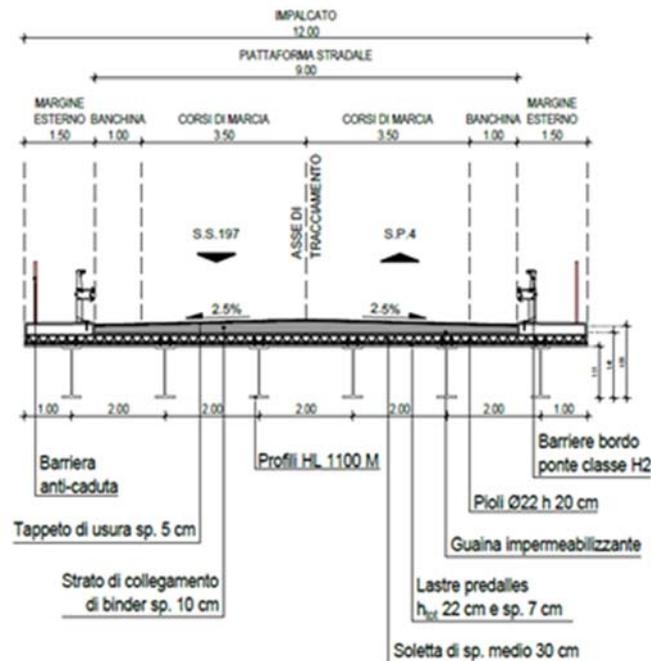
Ponti a sezione mista acciaio/calcestruzzo
